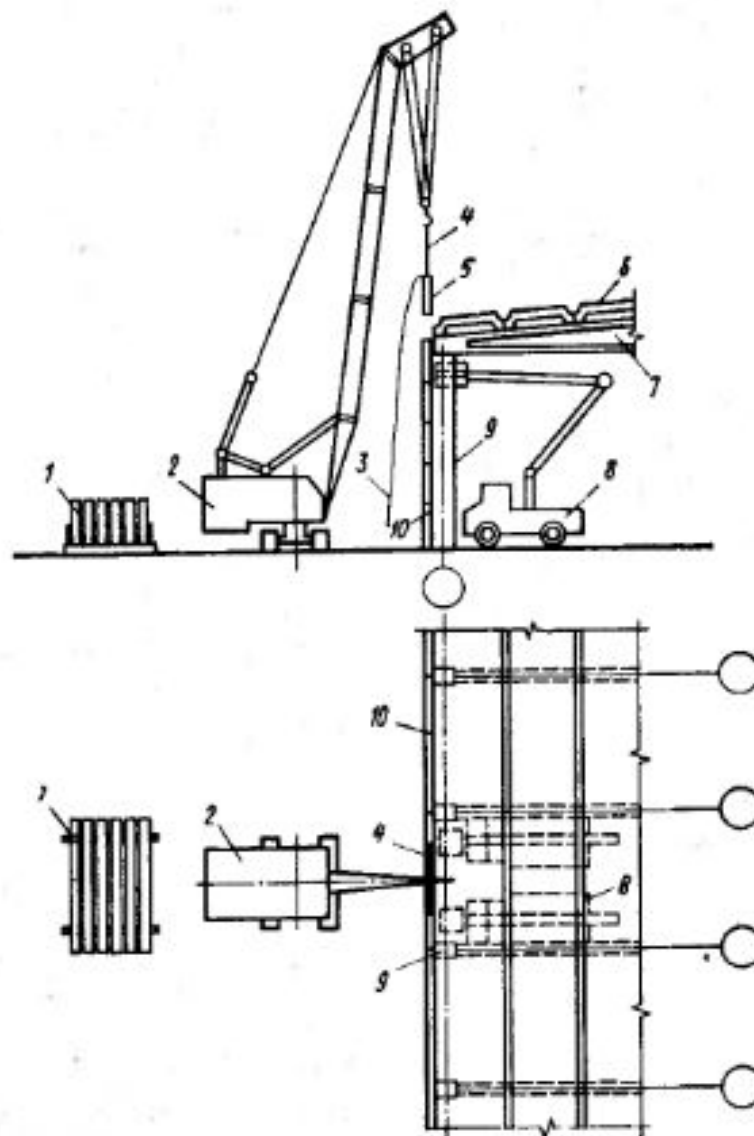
Схема монтажа стеновых ограждающих панелей, кассета расположена между краном и стеной:
